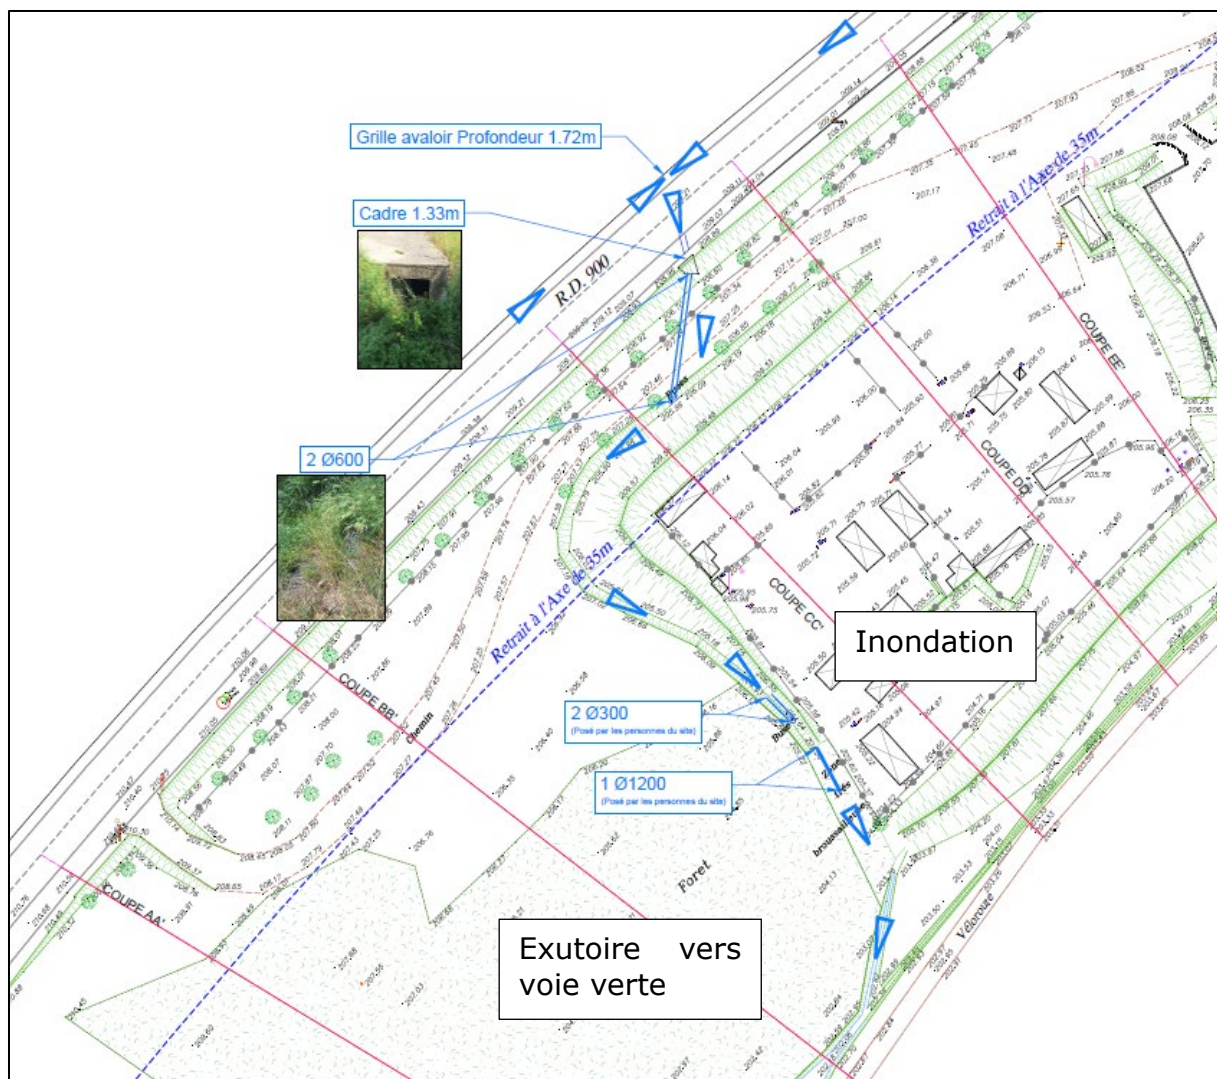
Plan du fonctionnement hydraulique actuel du site
